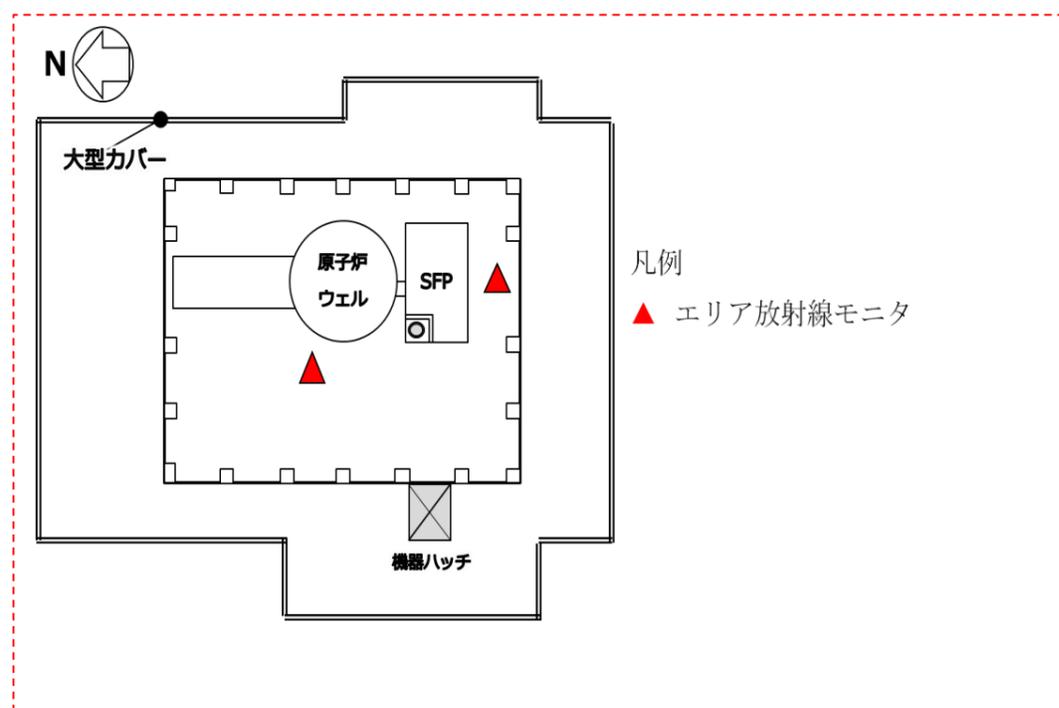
1号機使用済燃料貯蔵プールエリアのエリア放射線モニタ配置図
